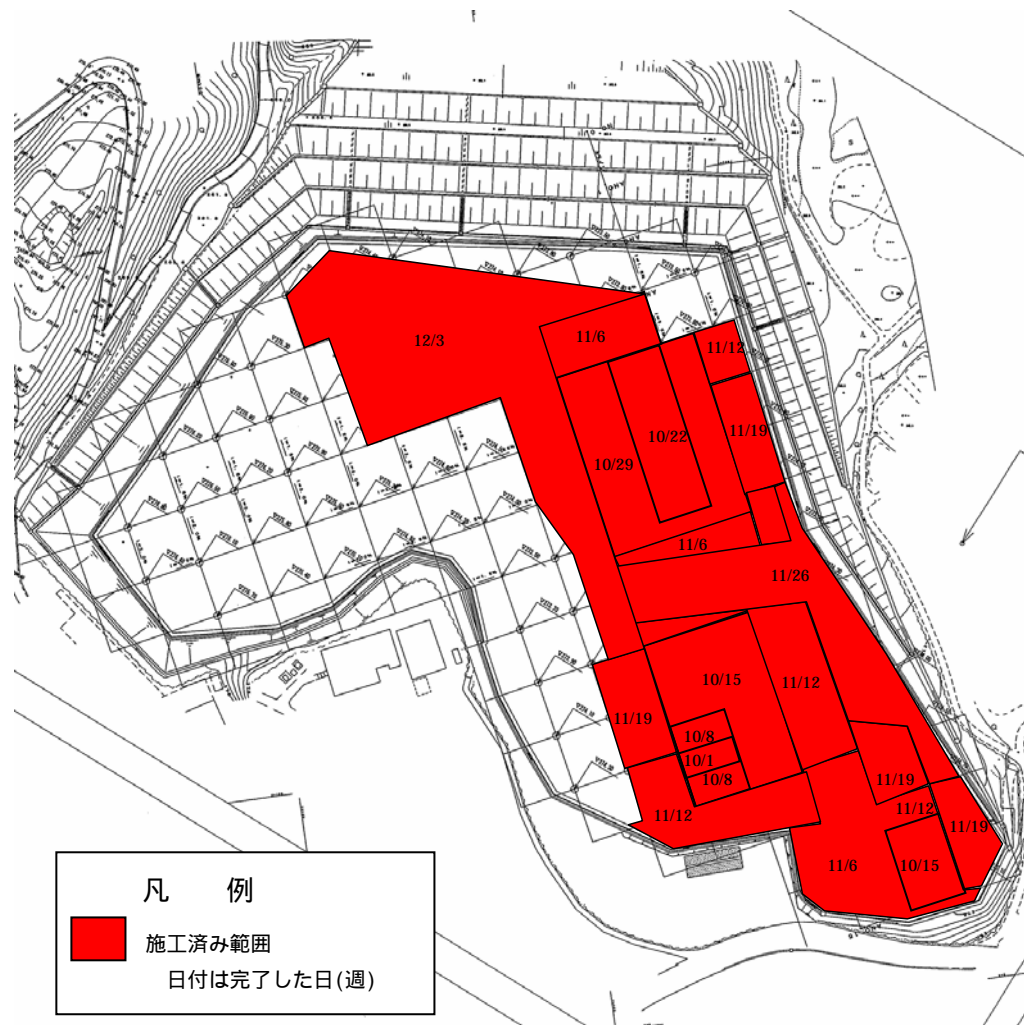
覆土工（ベントナイト混合土）の施工状況
